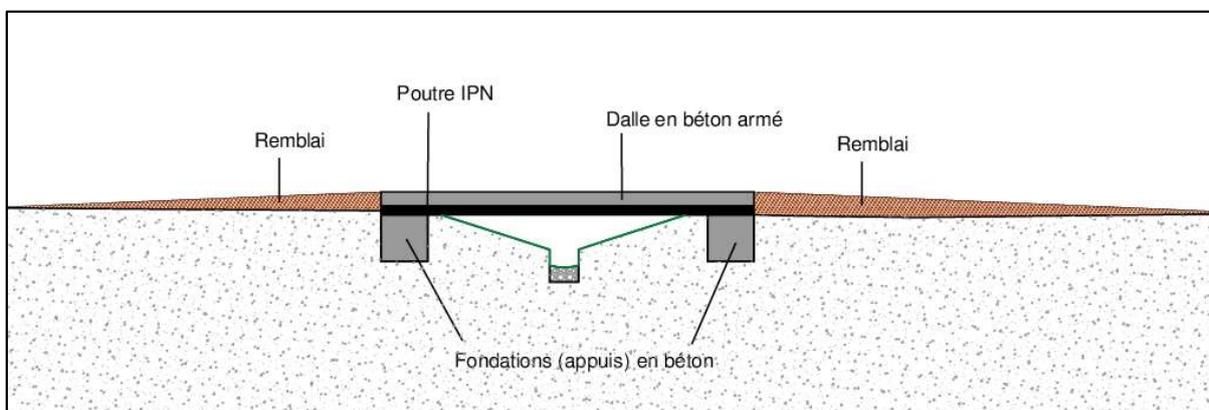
Eléments constitutifs d'une passerelle mixte métal - béton
